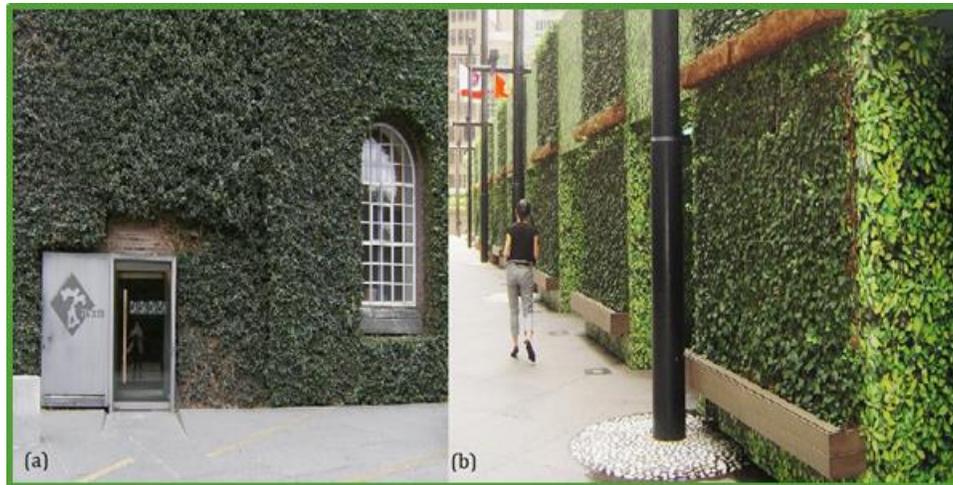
Clasificación de fachadas verdes: (a) fachada verde directo, casa particular, Golegã, Portugal., (b) fachada verde indirecta. Fuente : Manso y Castro ,2016.
